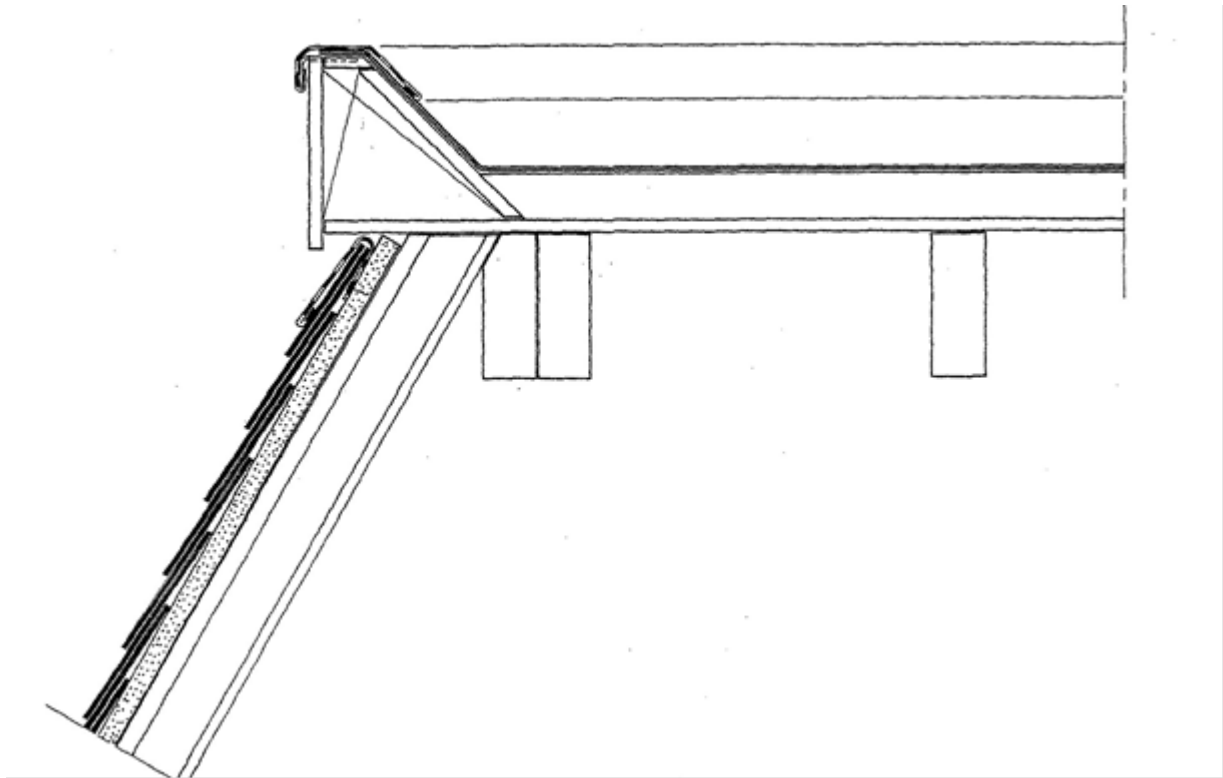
B: Nokaansluiting aan plat dak (gesloten ondergrond)
